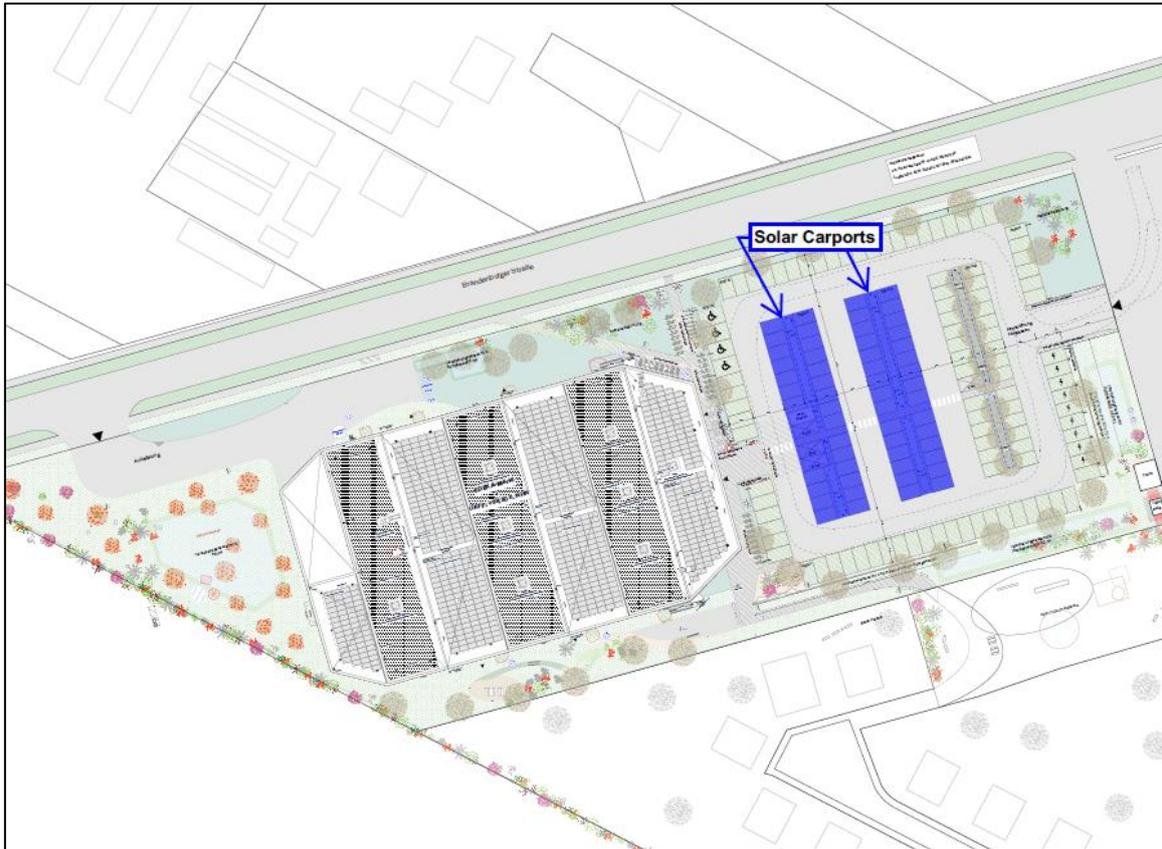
Lageplan EDEKA-Zukunftsmarkt mit Verortung der Solarcarports auf der Fläche für Stellplätze (in blau) (Quelle: Lageplan ZRS Architekten GvA mbH, Stand: 21.06.2022)
